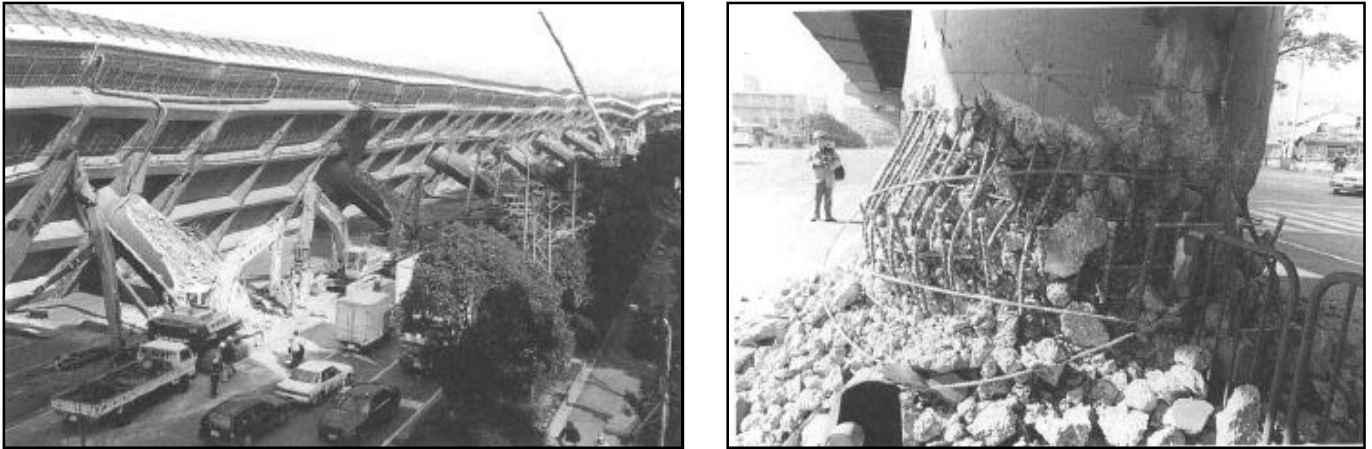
Ejemplos de fallas en columnas durante el sismo de Kobe de 1995; (izq.) Falla a flexión en la base de las columnas del puente Hanshin, (der.) Falla de la columna en la soldadura del refuerzo longitudinal. Priestley et al., (1996)
